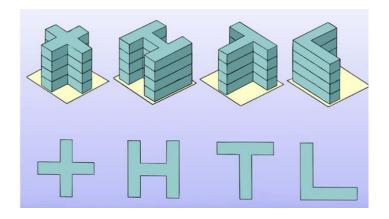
Formas de estructuras con irregularidad en planta. Fuente: (Rodríguez, 2006).
